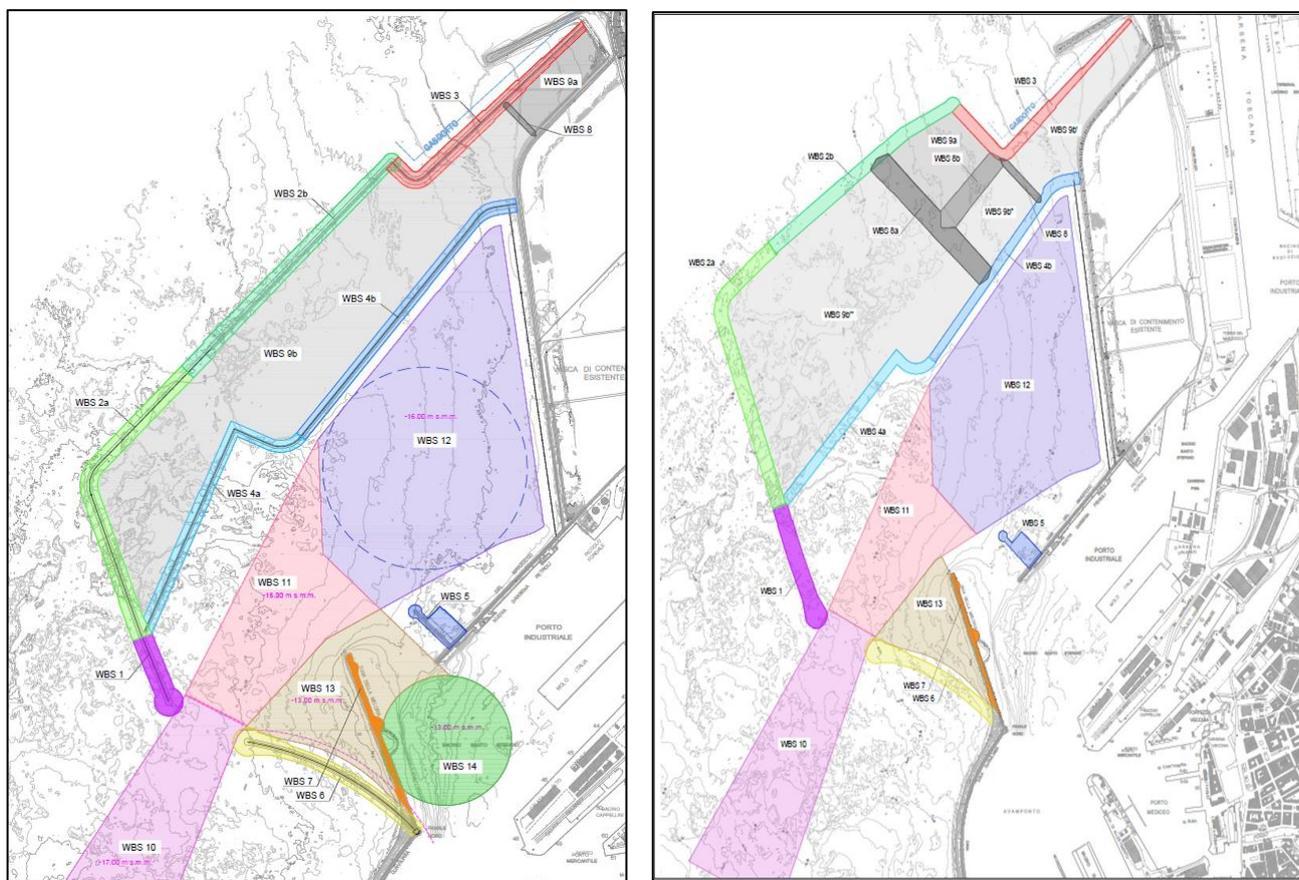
Confronto tra layout del Progetto Definitivo Semplificato e layout del presente Progetto Definitivo
